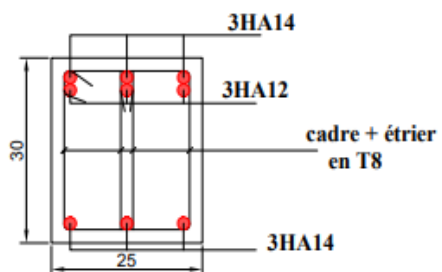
Ferrailage des poutres secondaires (Zone 2,3)
